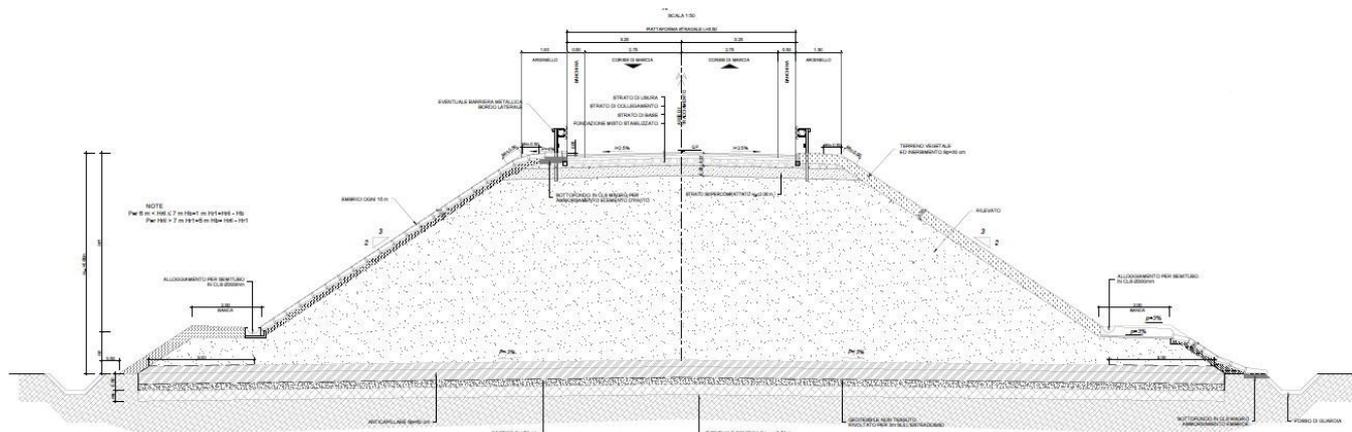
Dest. Particolare 6.5m - sezione tipo in rilevato $H_{ril} > 6.00$ m
